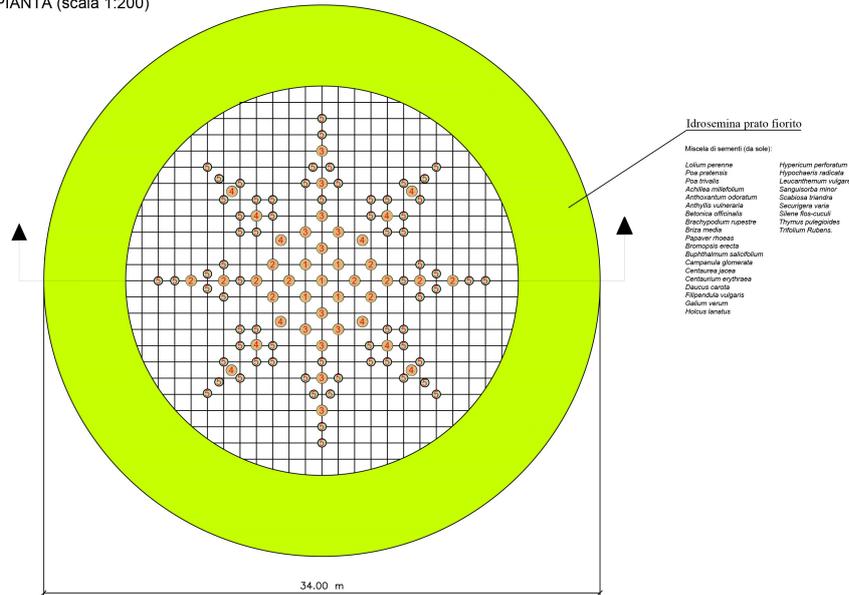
Pianta rotatoria modulo PI-RO 1
